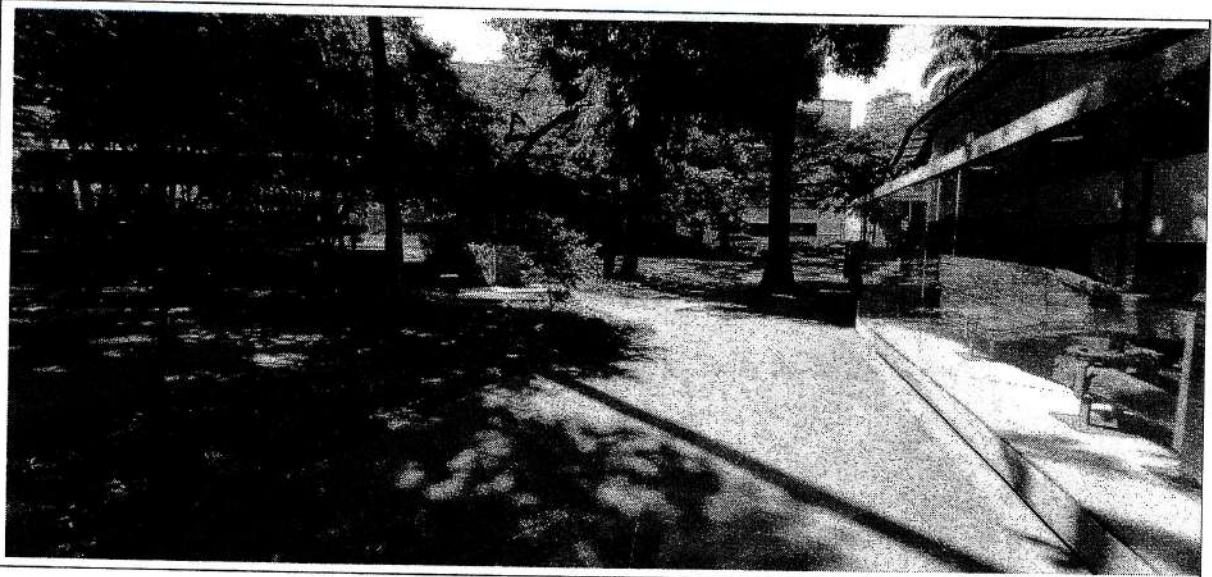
Circulação área externa – piso nivelado bem conservado. Não possui sinalização tátil.
